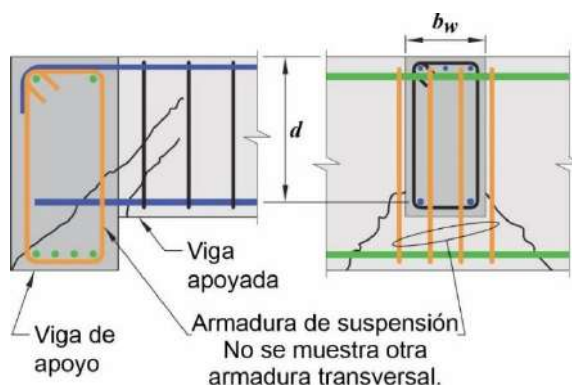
Armadura de suspensión para transferencia de corte
